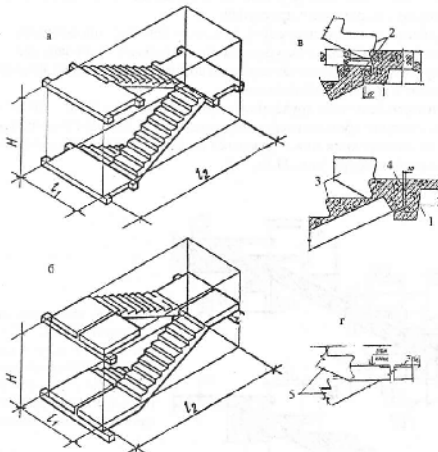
Стандартные сборные железобетонные лестницы: а – конструкция из 4-х сборных элементов; б – конструкция из двух Z-образных сборных элементов; в – узел опирания маршей на лестничную площадку; г – узел перехода марша в лестничную площадку при Z-образном лестничном элементе; 1 – этажная лестничная площадка; 2 – полнотельные лестничные марши; 3 – ребристые лестничные марши; 4 – цементный раствор; 5 – Z-образный сборный элемент
